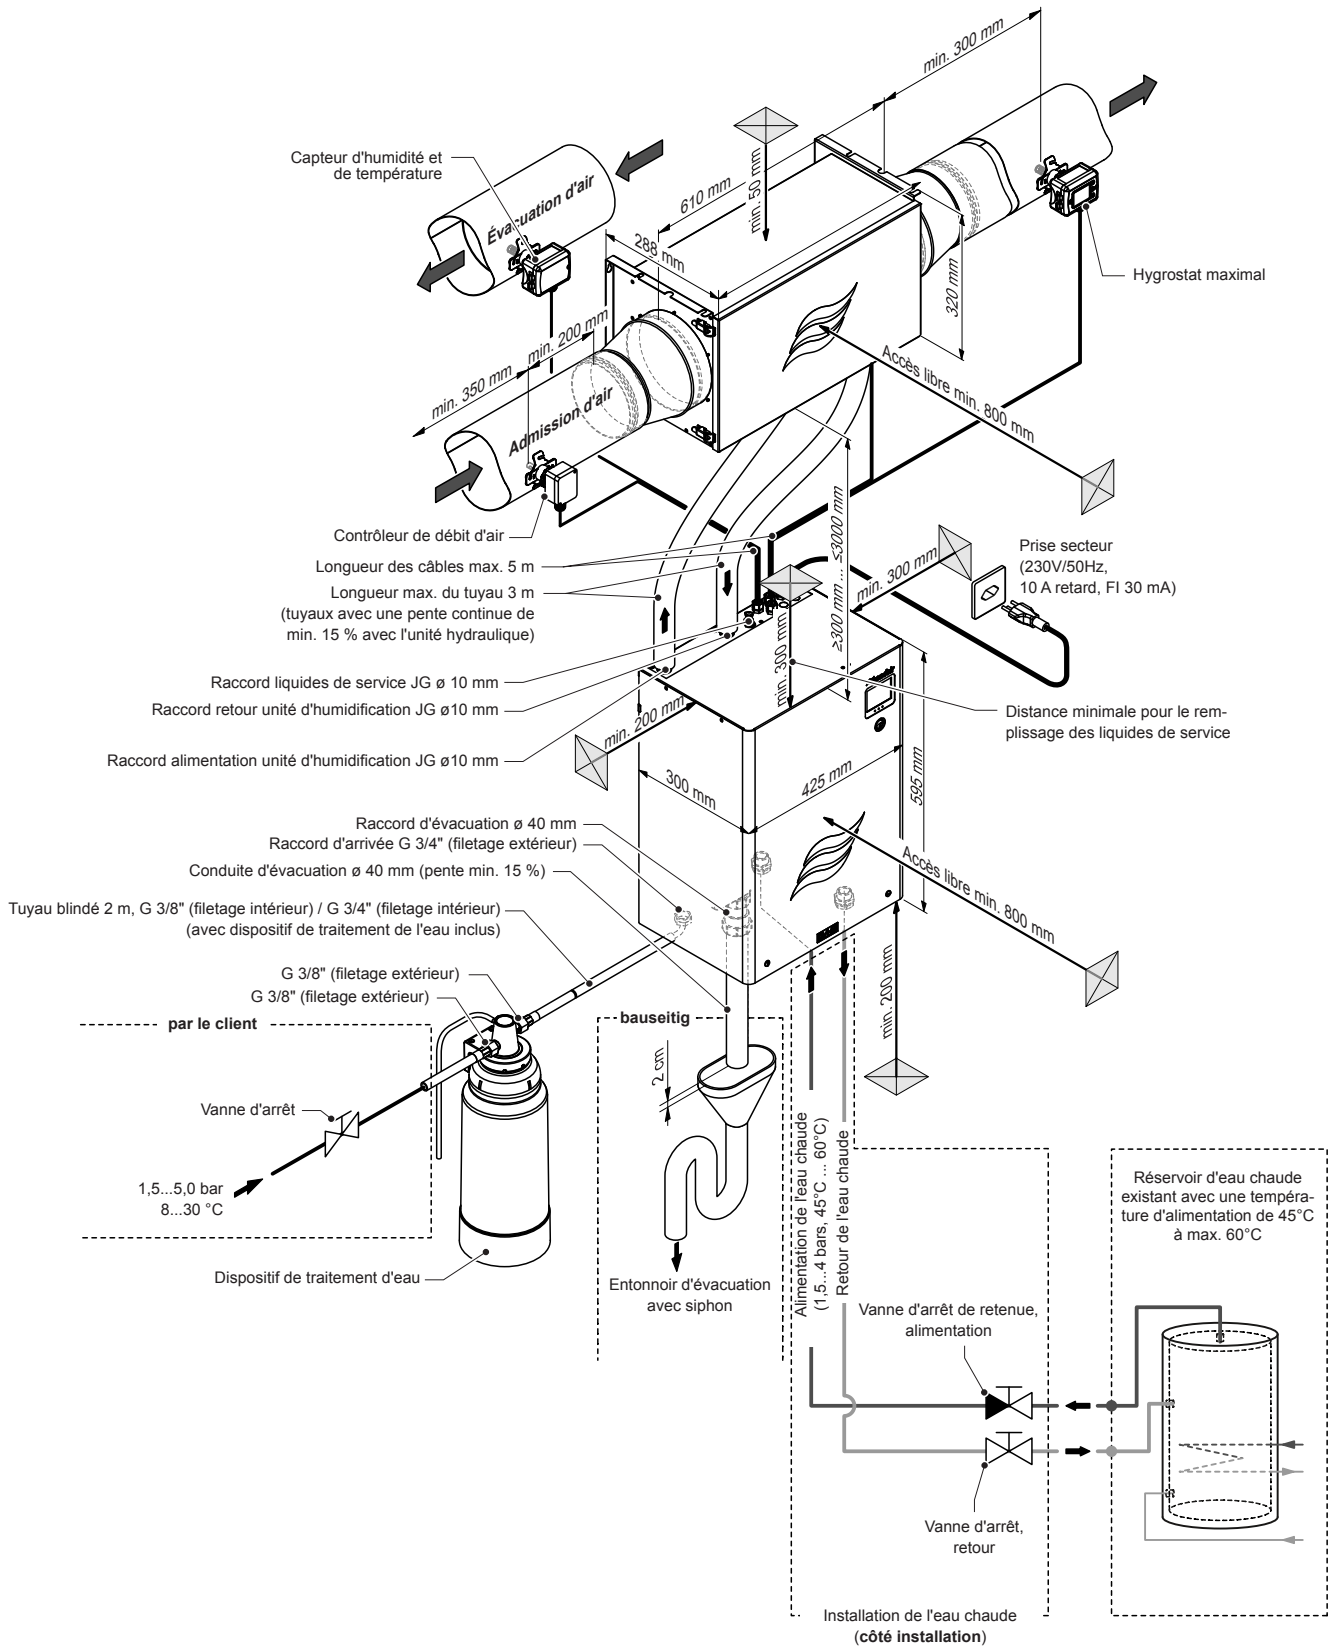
Aperçu de l'installation du Condair MD, variante MD-WW-H
